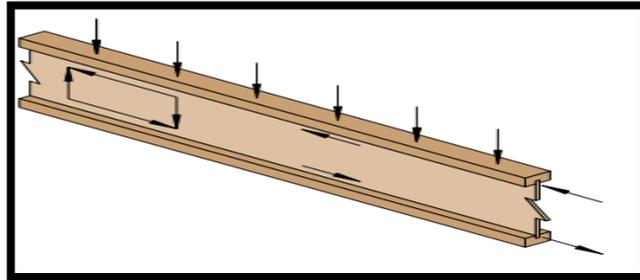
Transmisión de fuerzas en la viga I-joist. Fuente: Hanger Lesson by RedBuilt.
